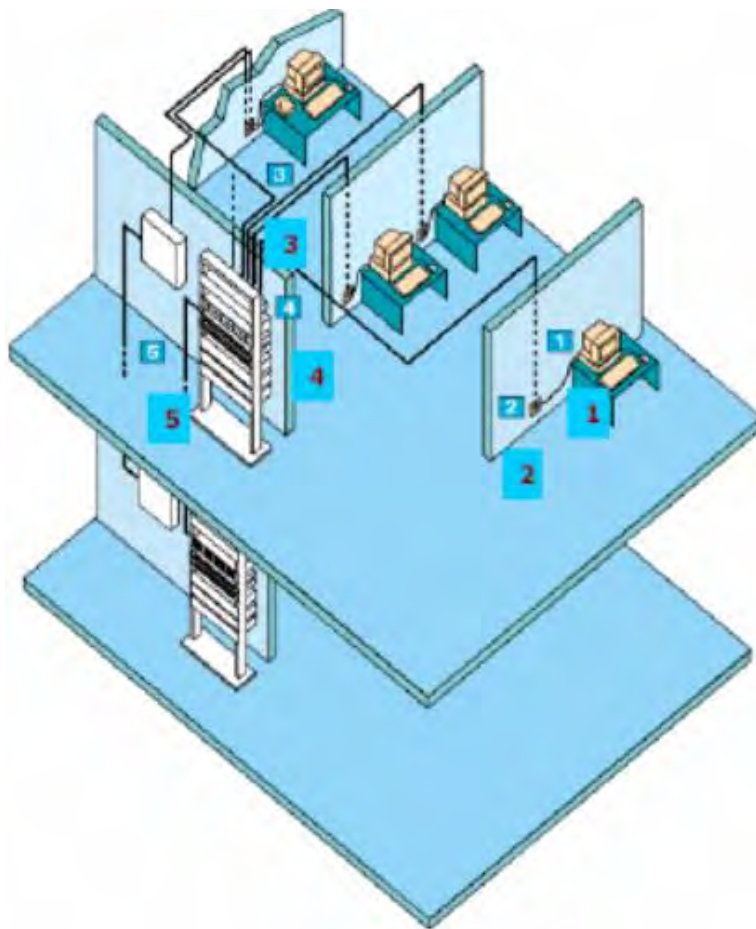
Estructura de un cableado estructurado. Fuente:
